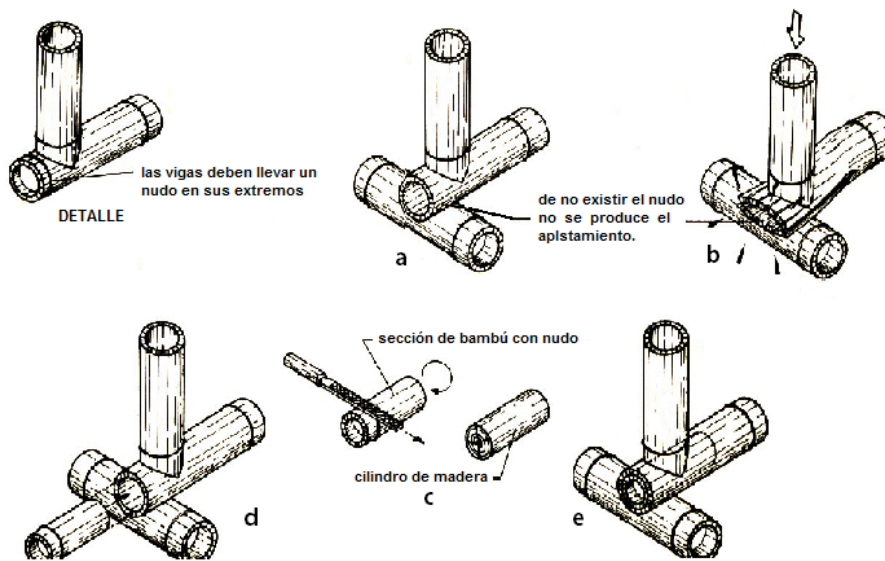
Formas de evitar el aplastamiento en los extremos de vigas
